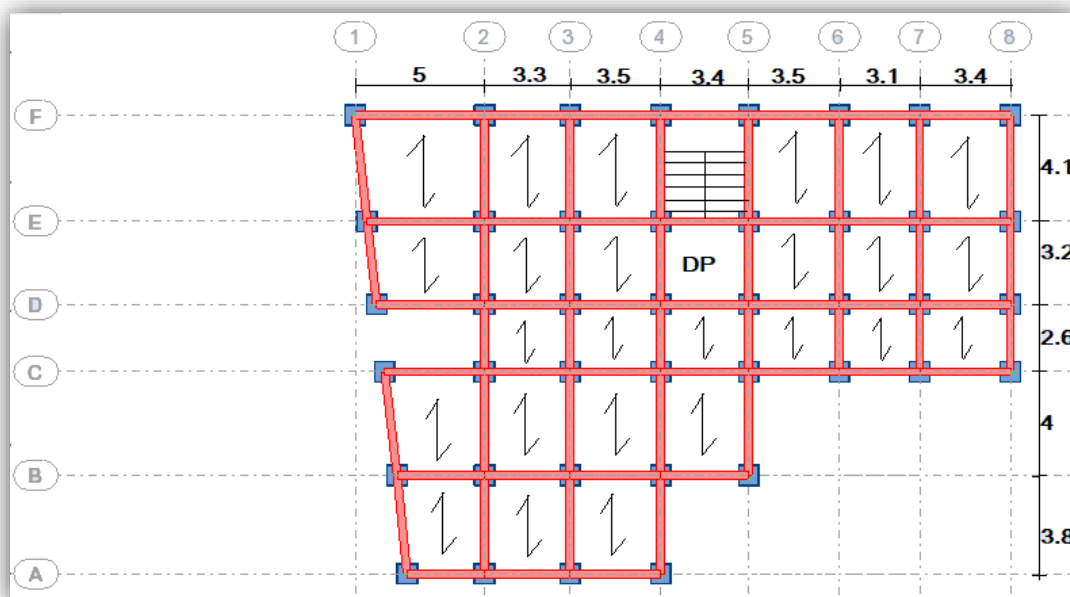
vue en plan du plancher et la disposition des poutrelles
